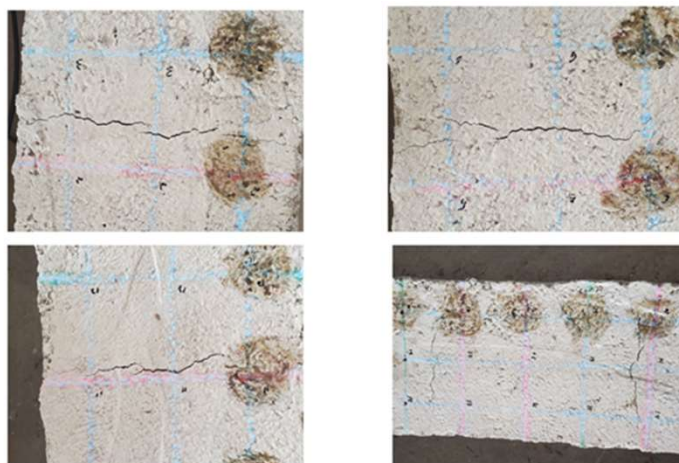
Grietas de la sección de estudio de la viga.
